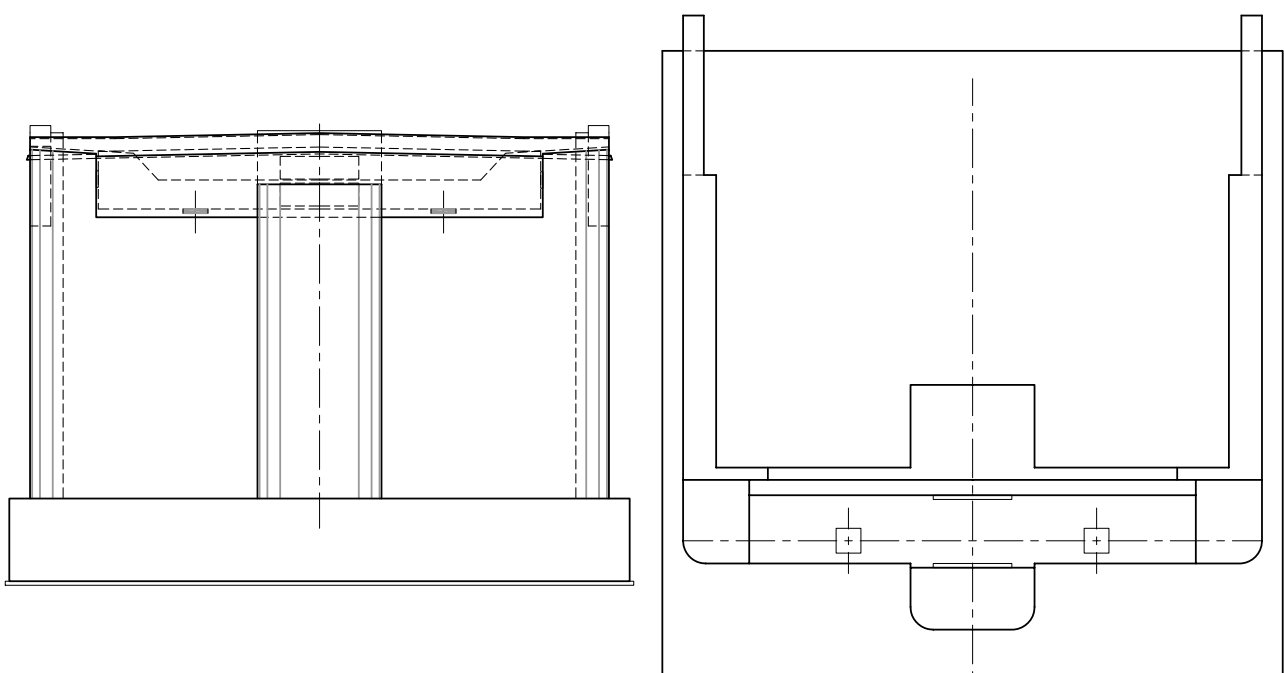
Estribo fijo de tablero tipo losa pretensada. Alzado y planta
